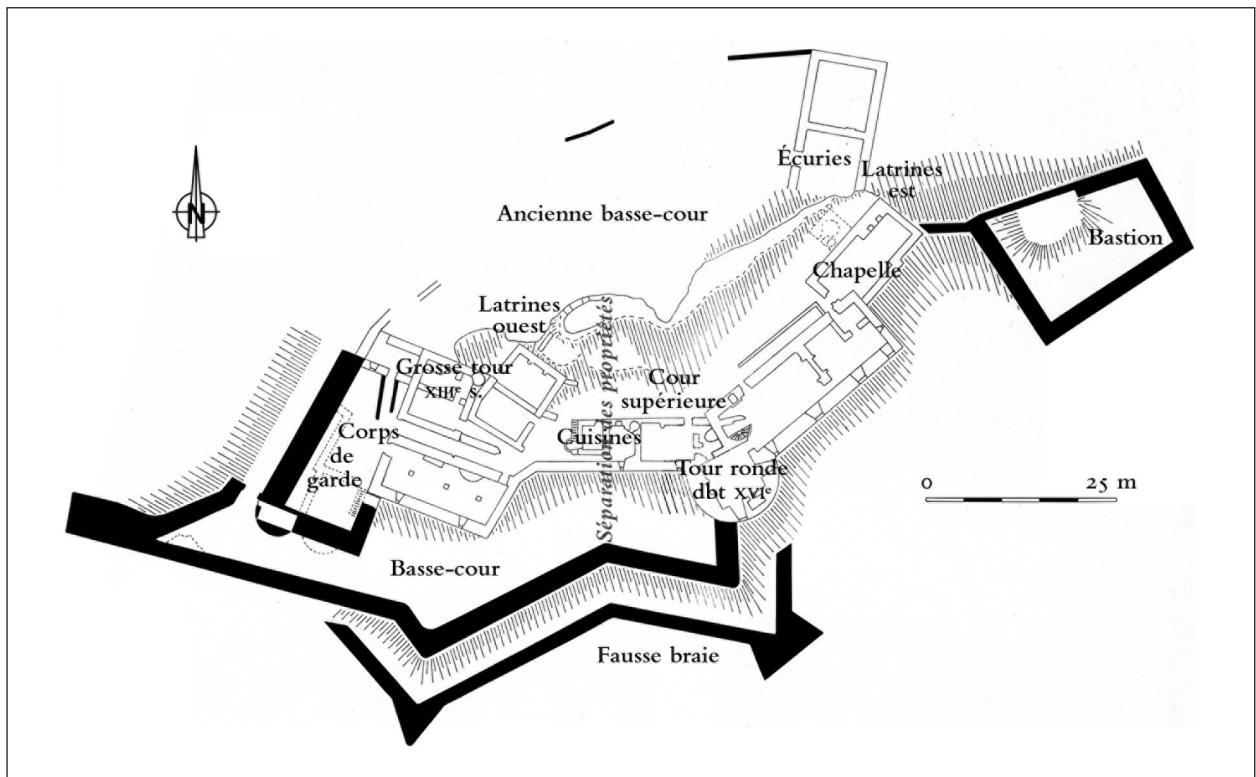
plan du château. En noir, les constructions de la fin du XVI^e siècle (dessin N.K.).
